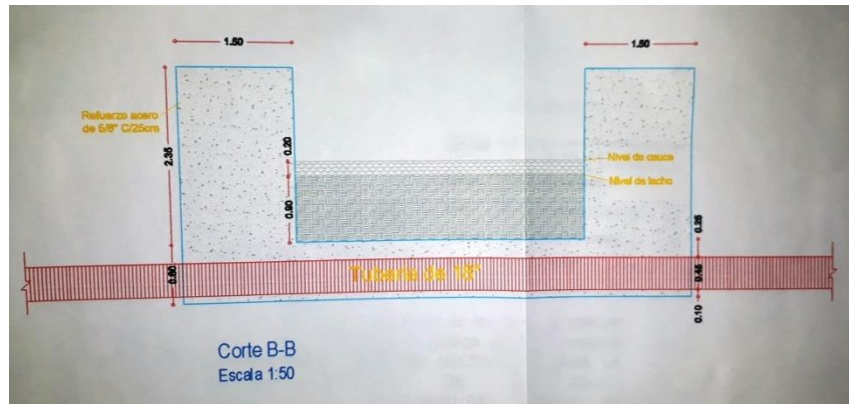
Detalle obra de cruce subfluvial, sección longitudinal.
